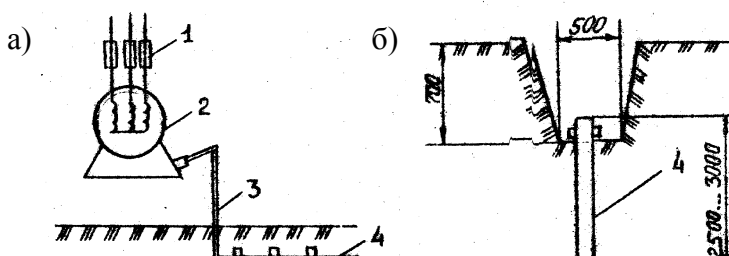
Устройство заземлителя: а- схема заземляющей сети; б - расположение одиночного заземлителя; 1 - плавкие вставки; 2- электродвигатель; 3 - соединительная полоса; 4 - трубчатый заземлитель
